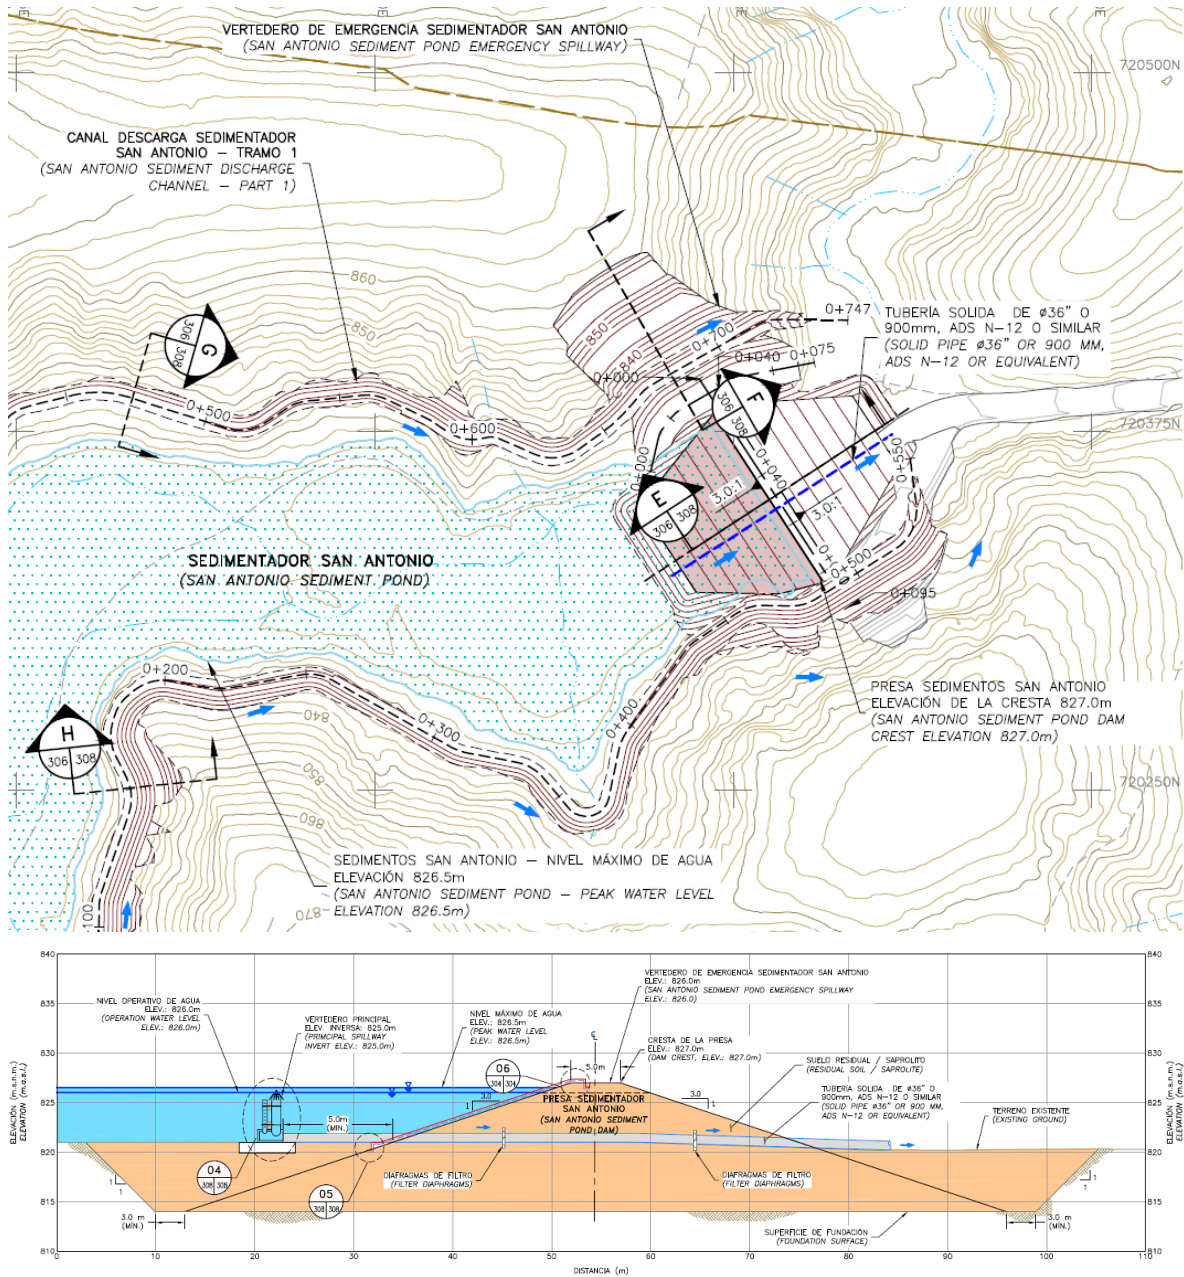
Planta Perfil del sedimentador San Antonio
